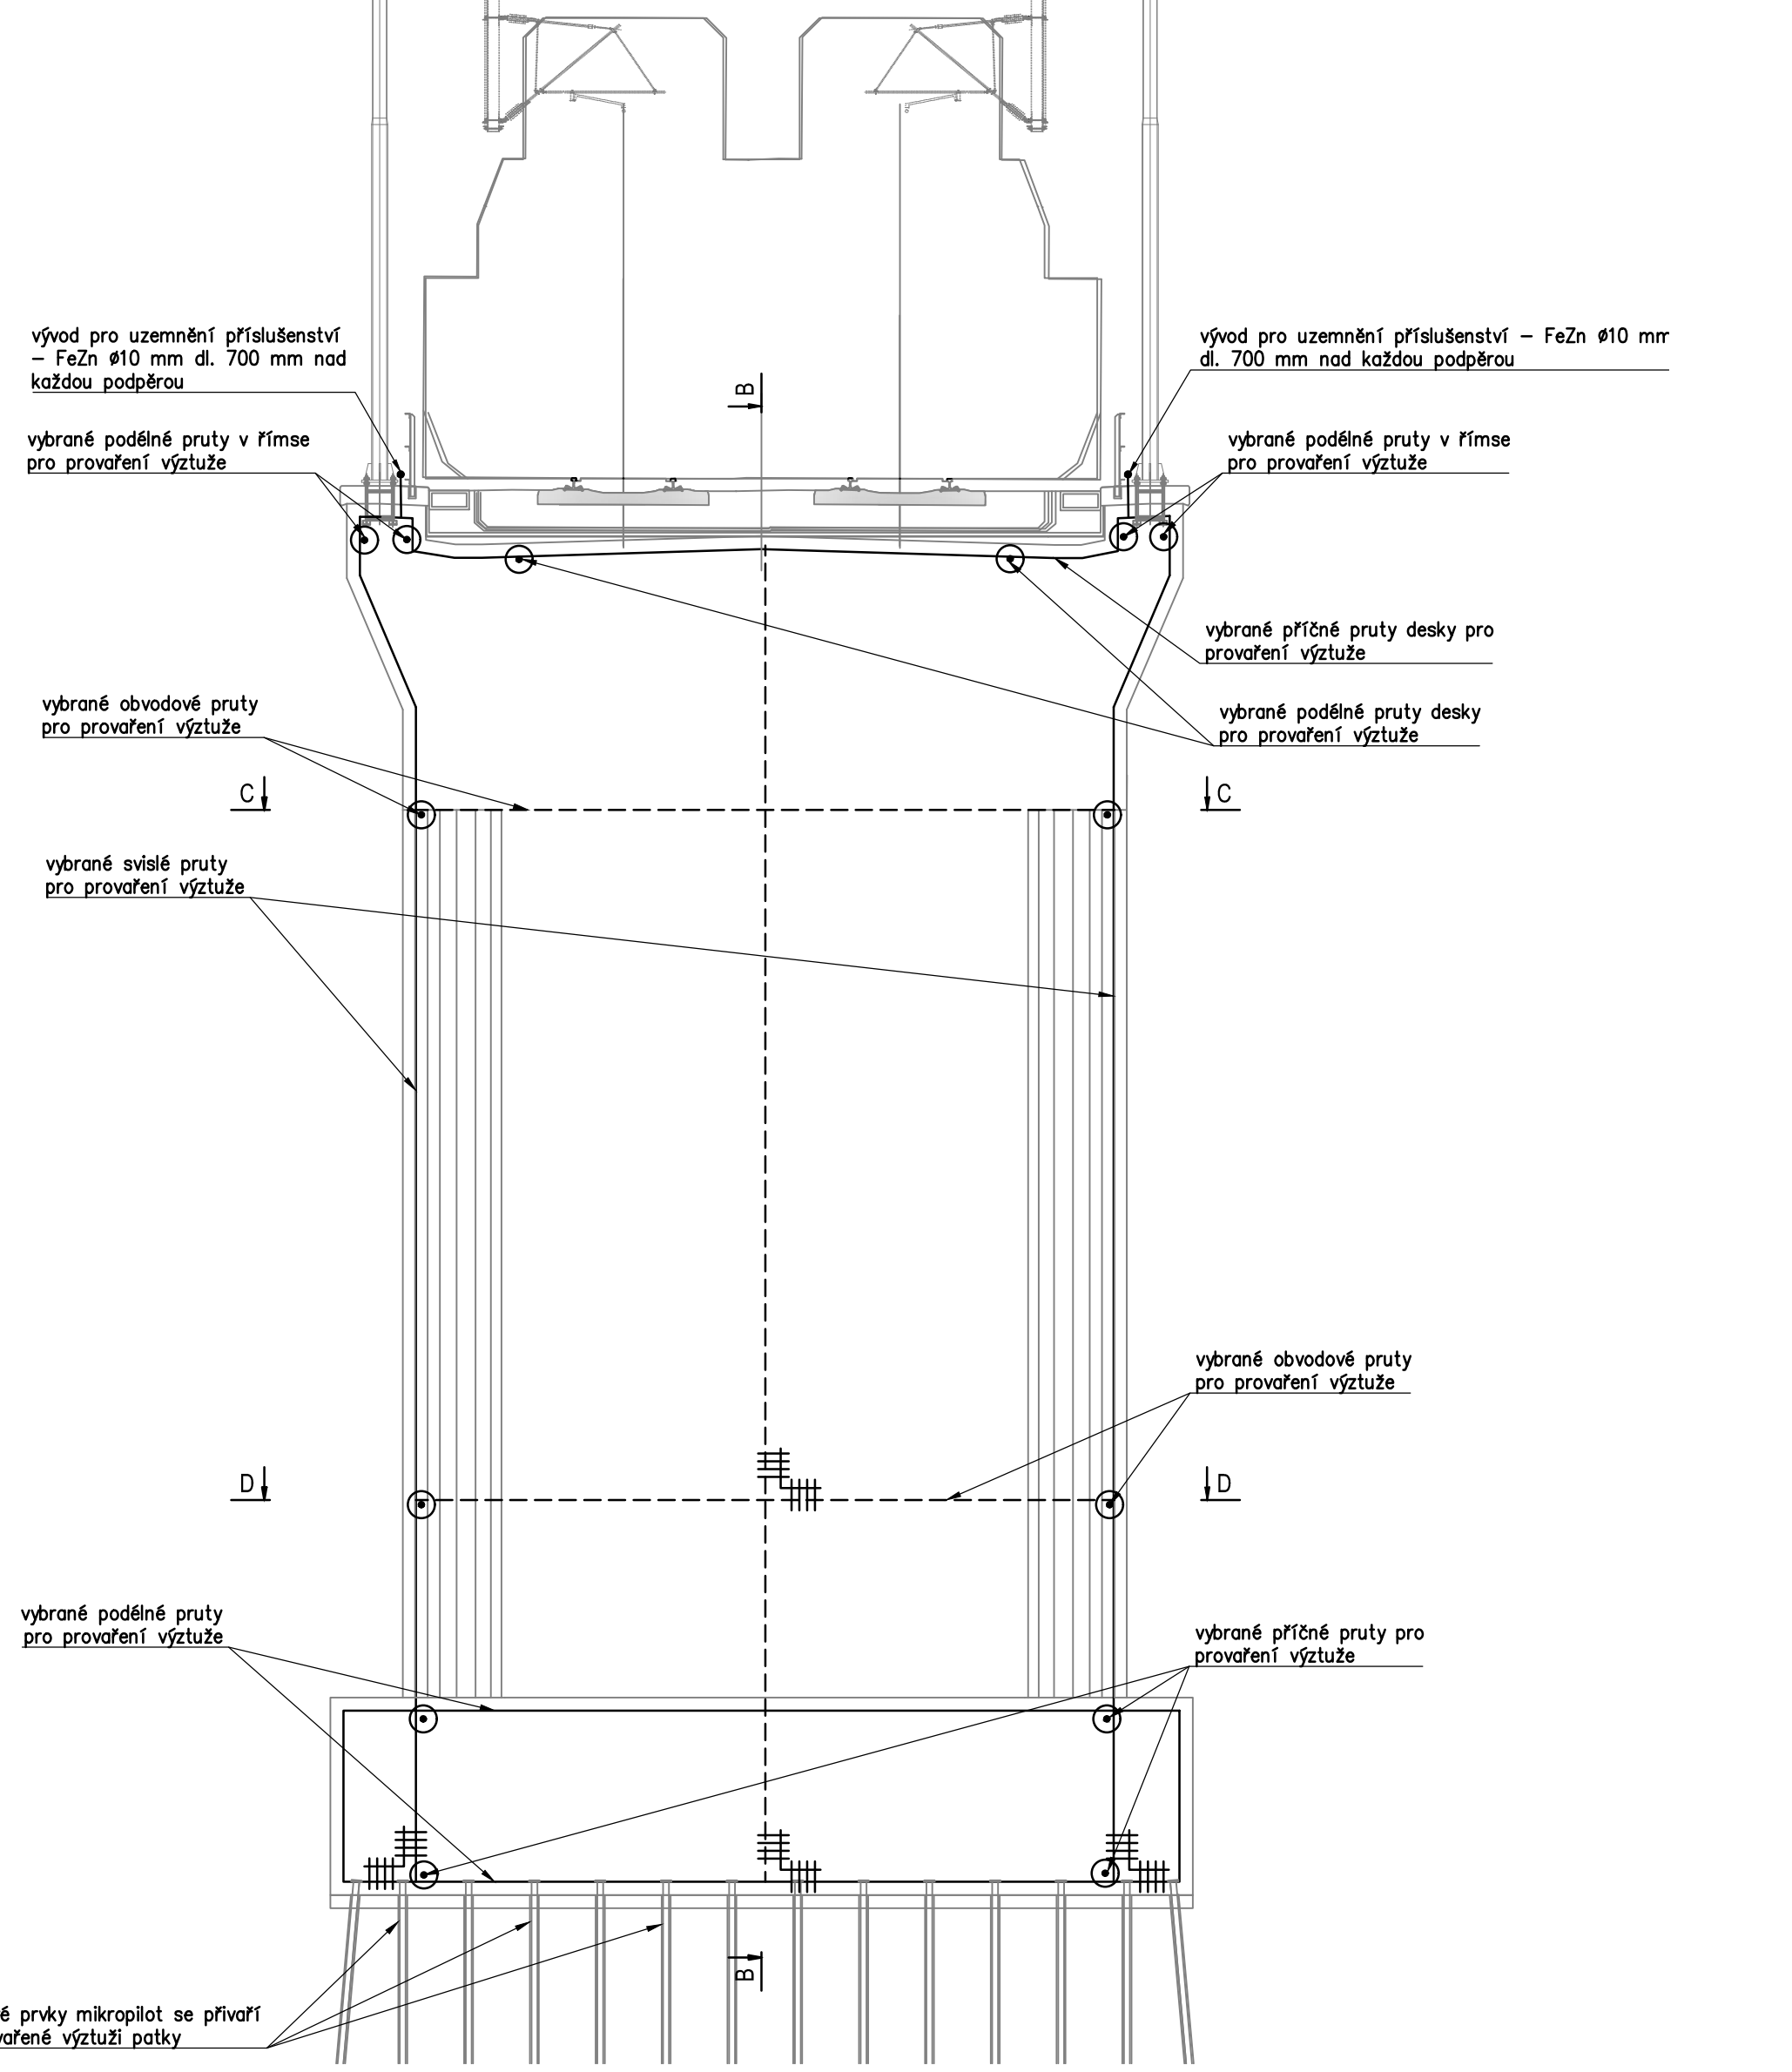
PODÉLNÍHO PROVAŘENÍ VÝZTUŽE
